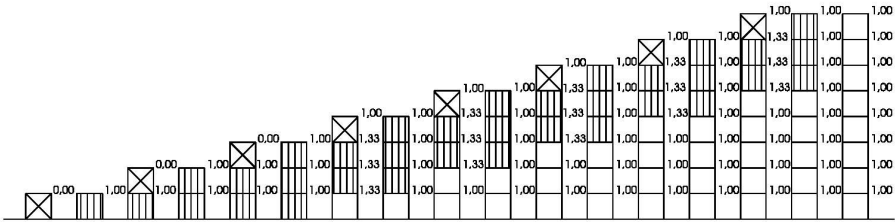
Factor de carga, en los forjados, con una planta cimbrada y dos recimbradas, en un edificio de ocho plantas, sobre solera infinitamente rígida.
